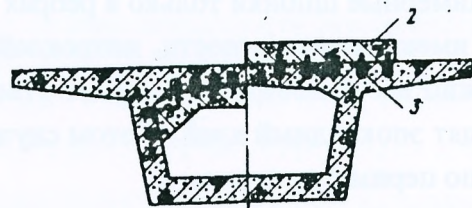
Схемы усиления дефектных стыков бетонированием дополнительных элементов: 1 – дефектный стык; 2 – бетон усиления; 3 – скважина с вклеенным штырем.
